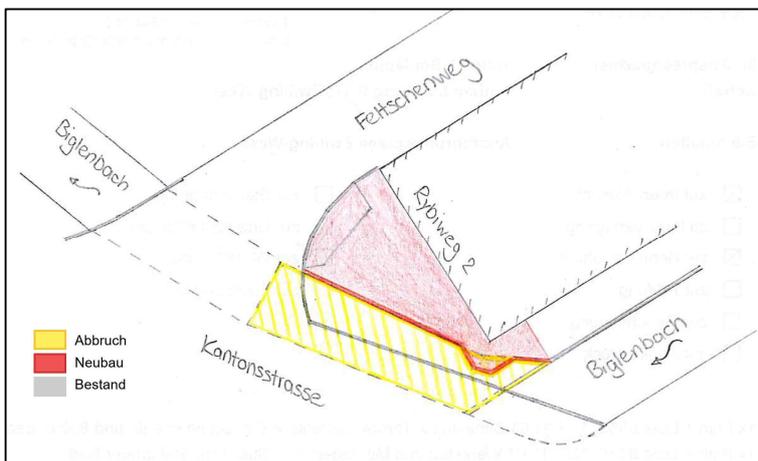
Grundriss Variante P1 "Offenlegung"
